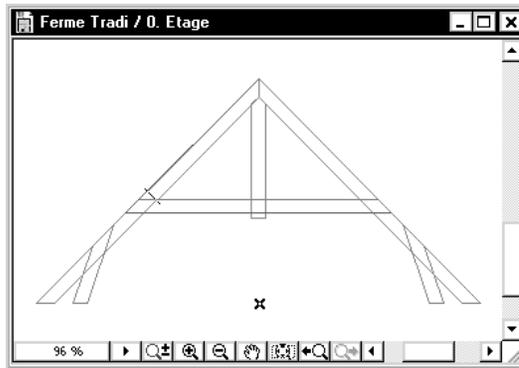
La ferme dessinée en plan dans la fenêtre plan
